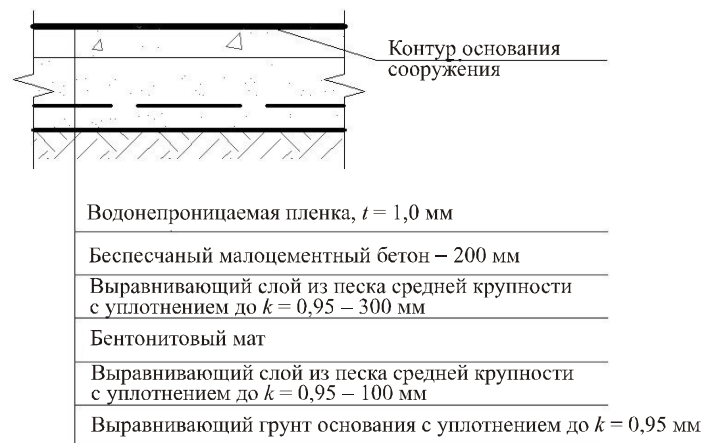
Схема конструкции гидроизоляции подземного бетонного массива сооружения
